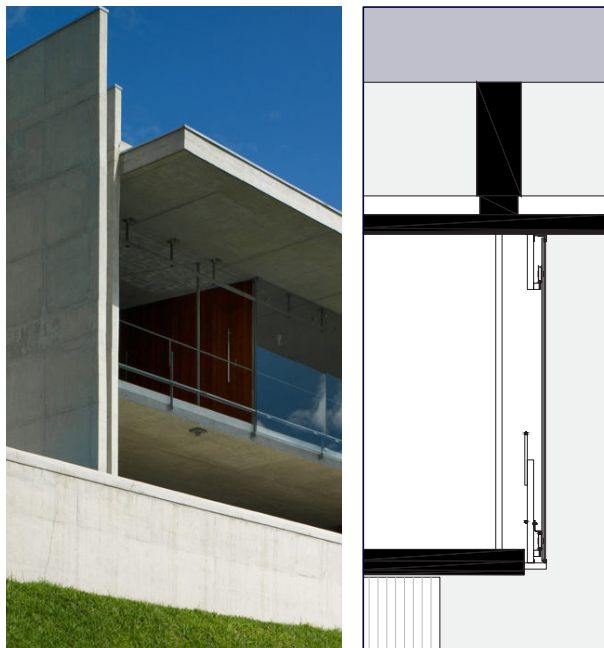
a) detalhe da fachada; b) detalhe do sistema de abertura do corpo elevado, Santa Teresa
